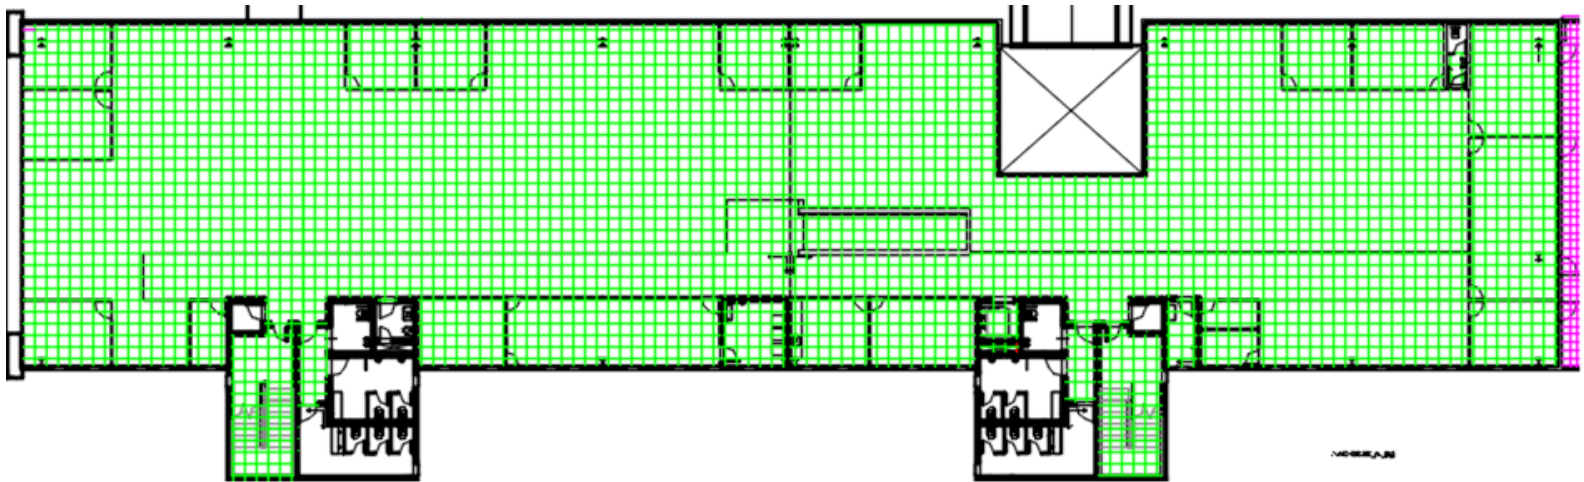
Lamina de planta arquitectónica de piso 2da planta propuesta 1
